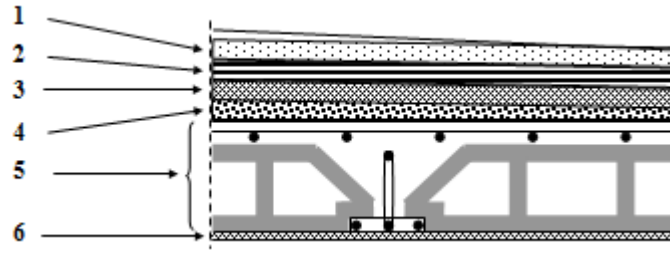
Coupe verticale d'un plancher terrasse inaccessible
